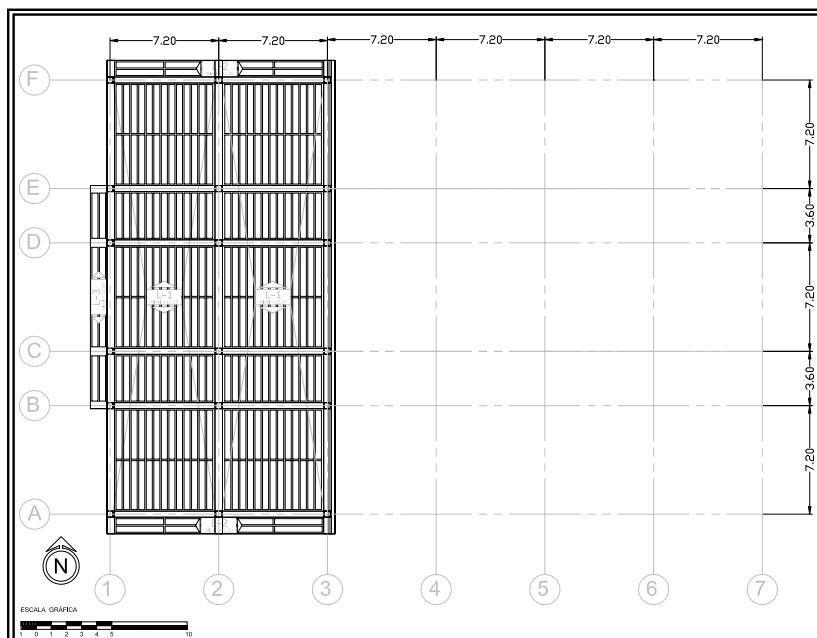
Plano de envigado en planta, nivel 4 (apéndice), mostrando la dirección de armado de losas
